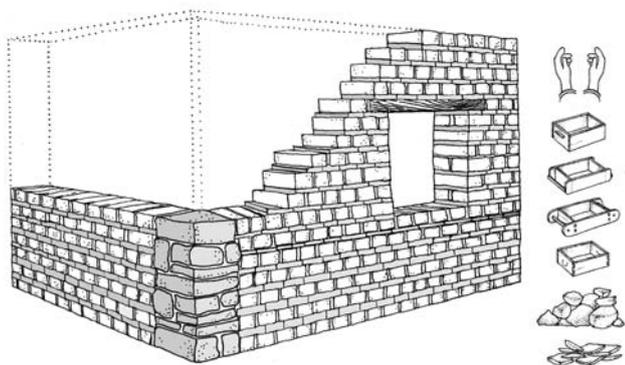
Fábrica con hiladas alternas de adobe y lajas de piedra.
